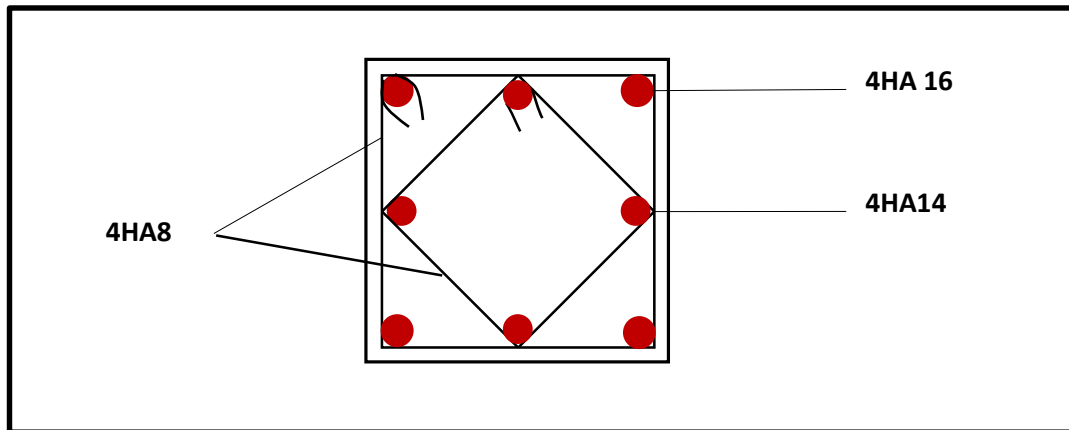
Ferrailage Poteau 40x40.
